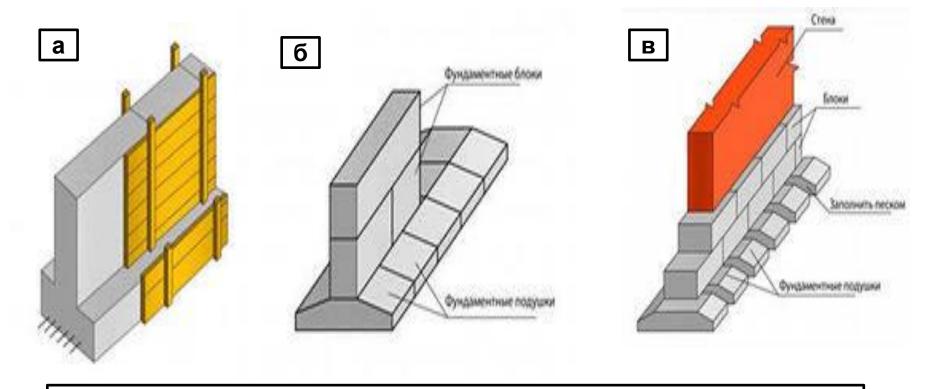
Схемы фундаментов: А — общий вид; Б — конструктивные схемы фундаментов малоэтажных жилых зданий:
